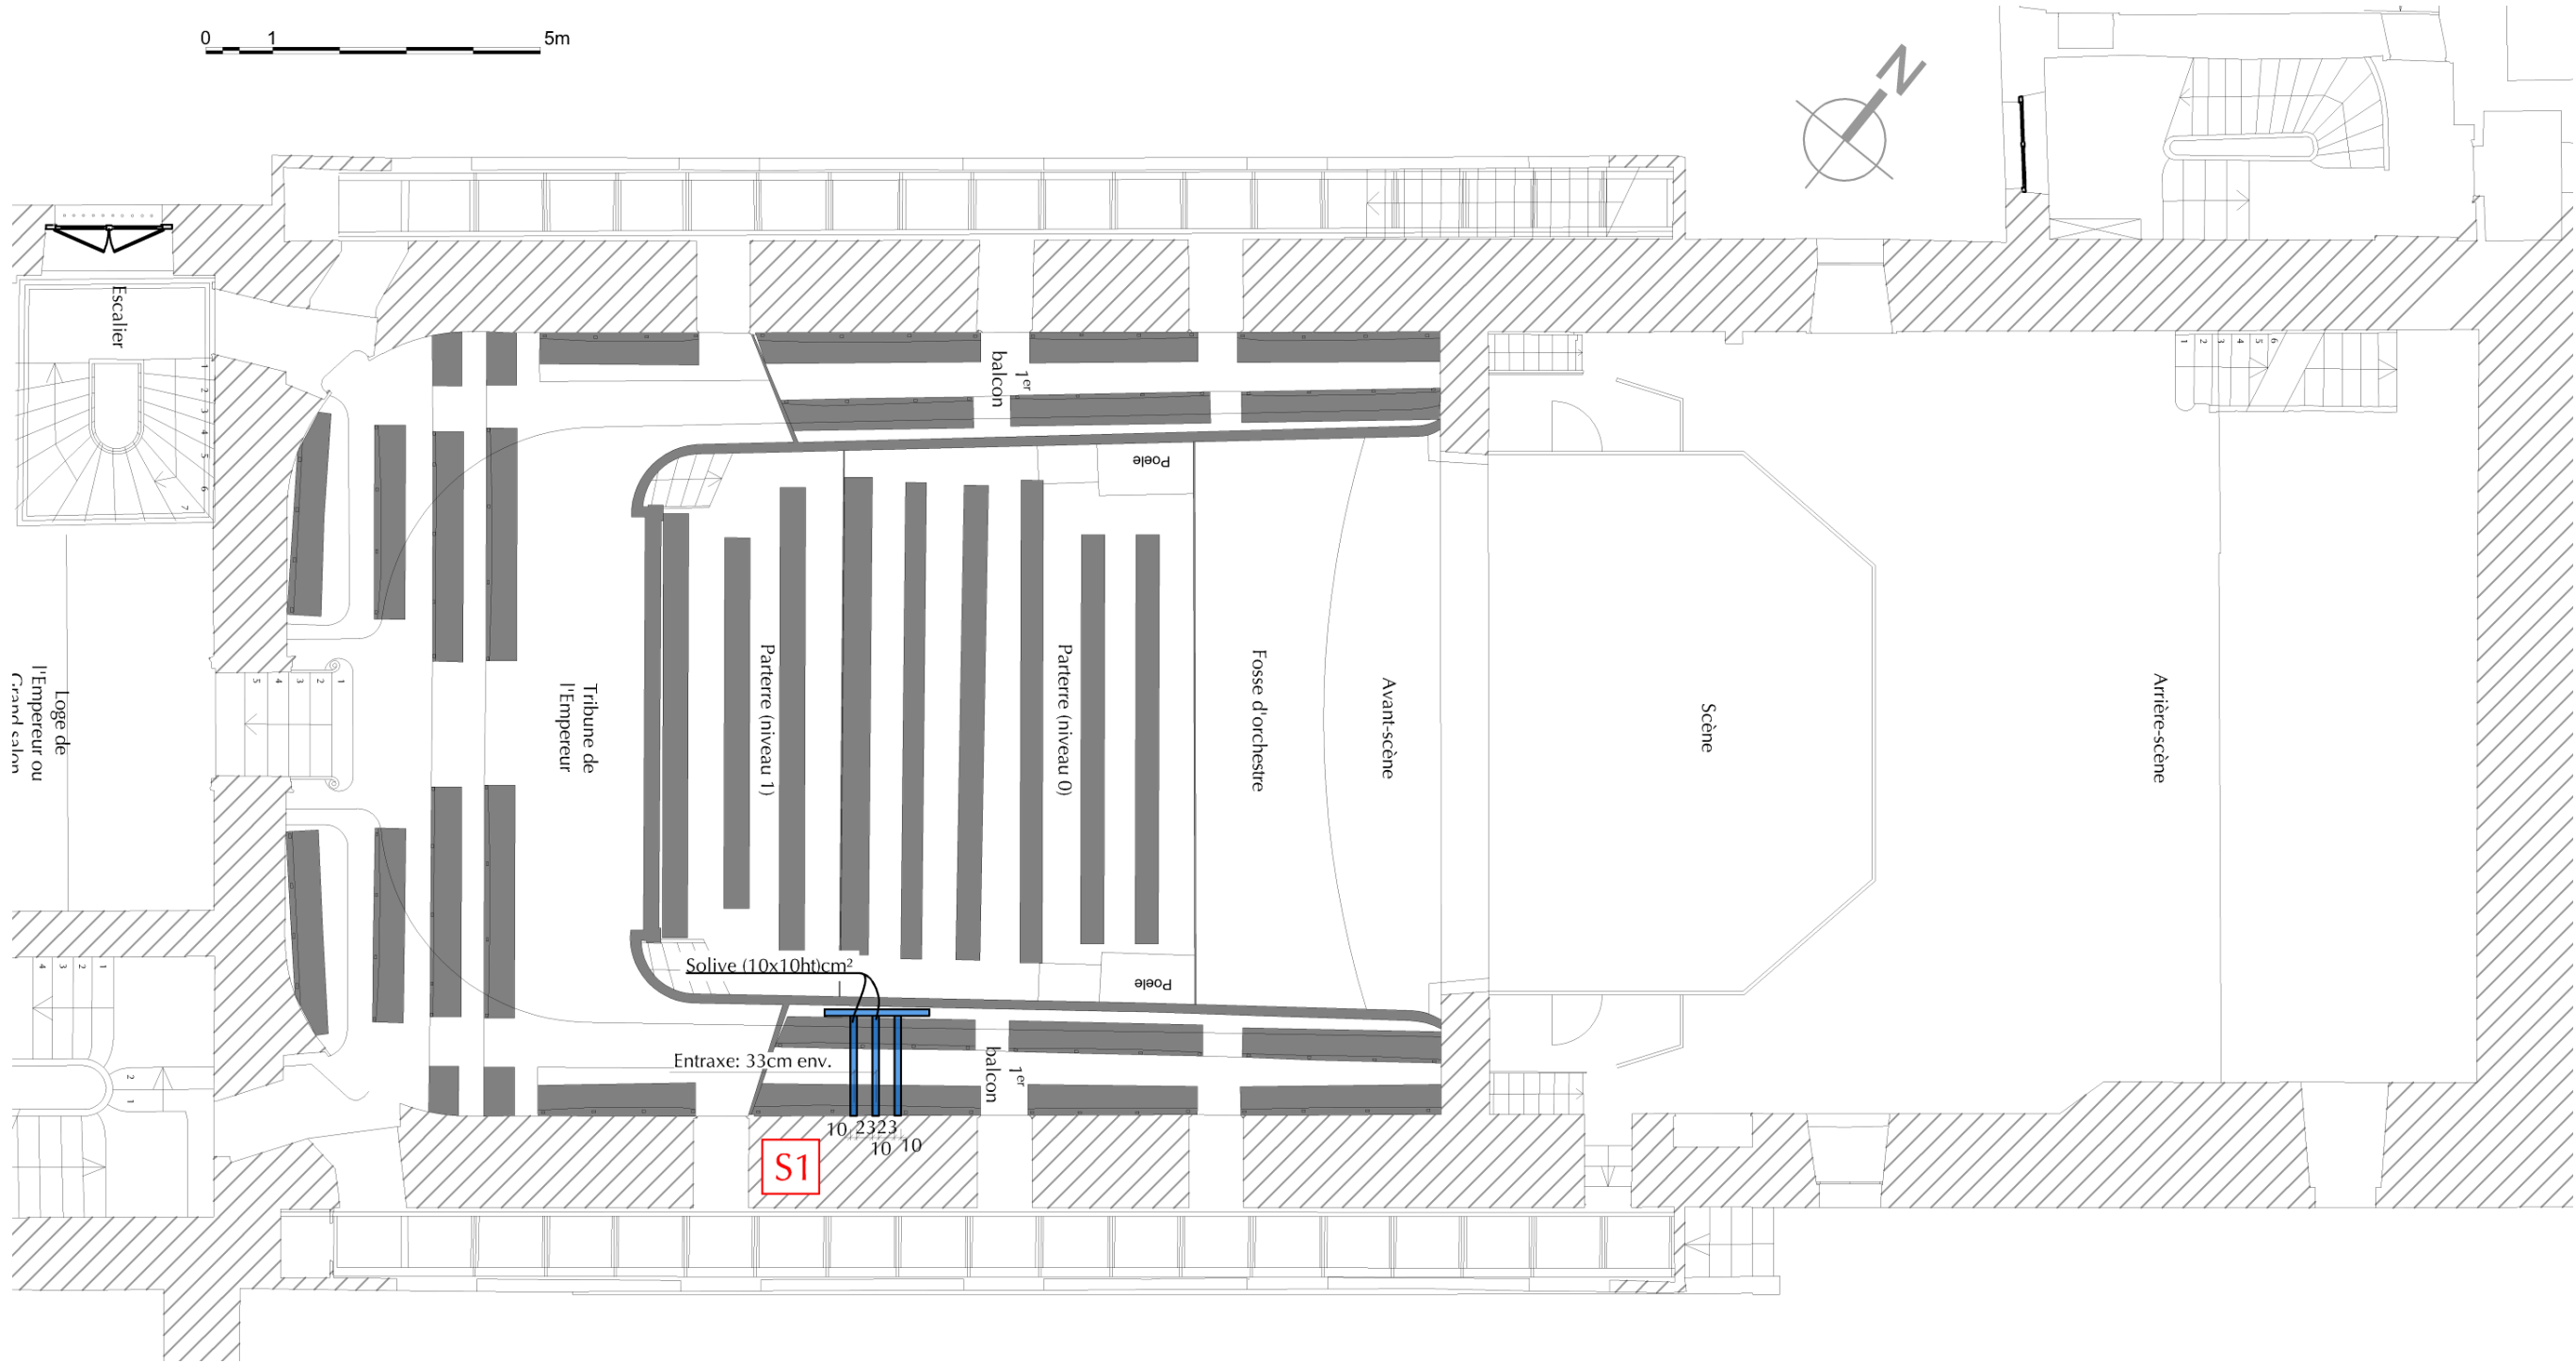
Vue plan du 1^{er} balcon – Plan de localisation sondage
